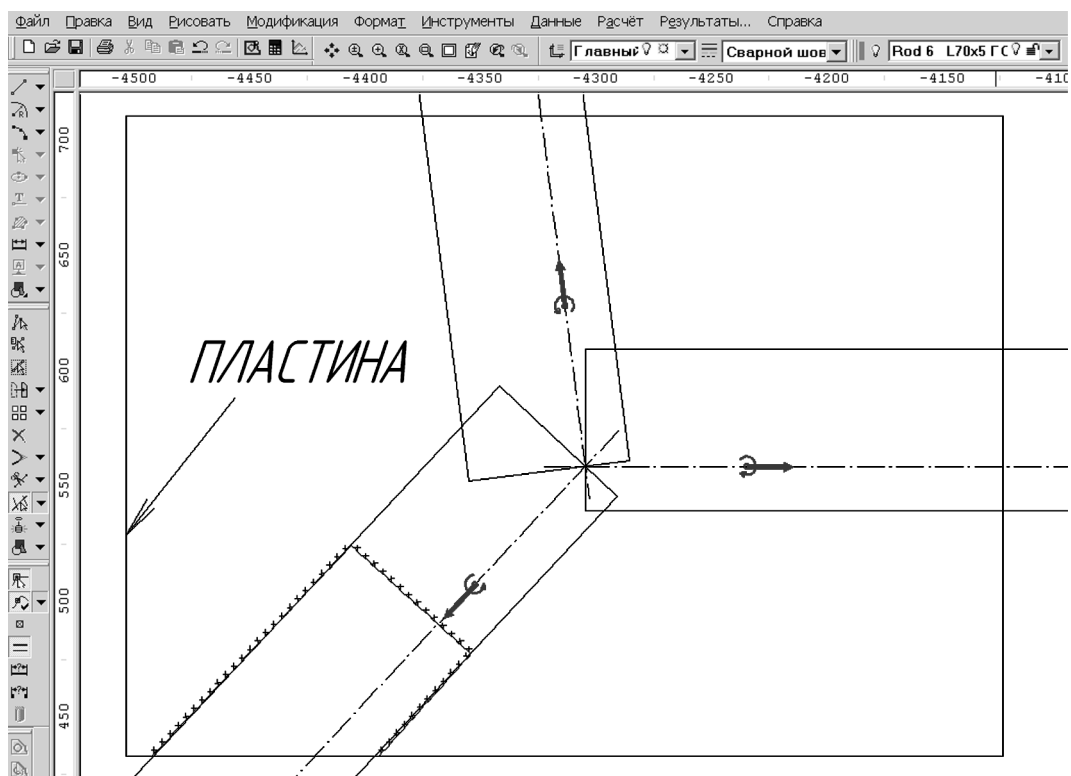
Конфигурация сварного шва, соединяющего стержень Rod 6 и вспомогательную пластину
